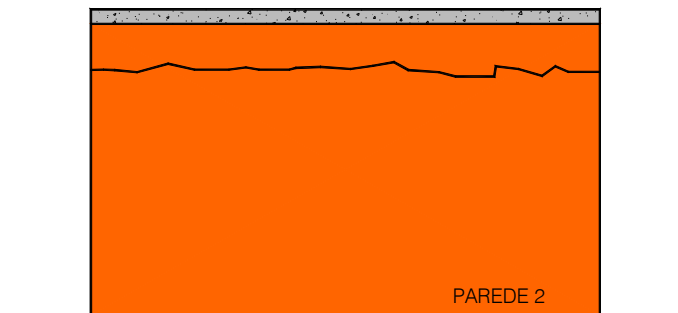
Fissura típica presente no topo da parede paralela à largura da laje [30]
